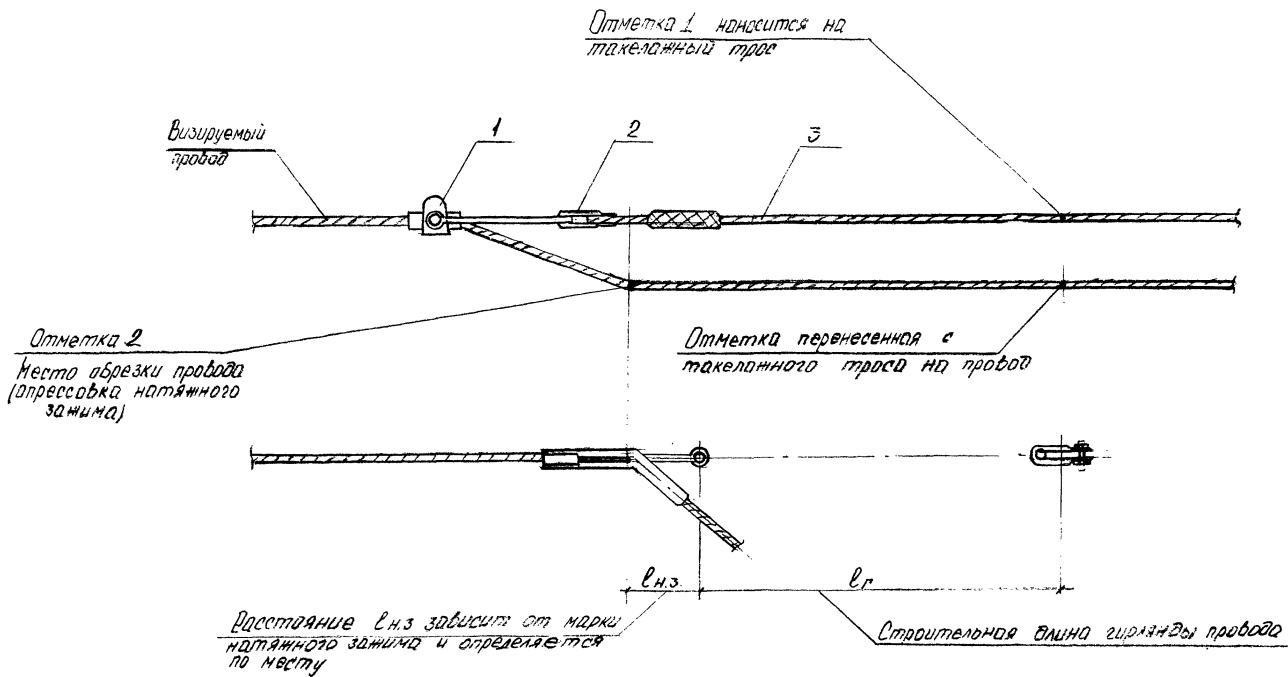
Схема передачи отмечок с тягелонного троса на провод
